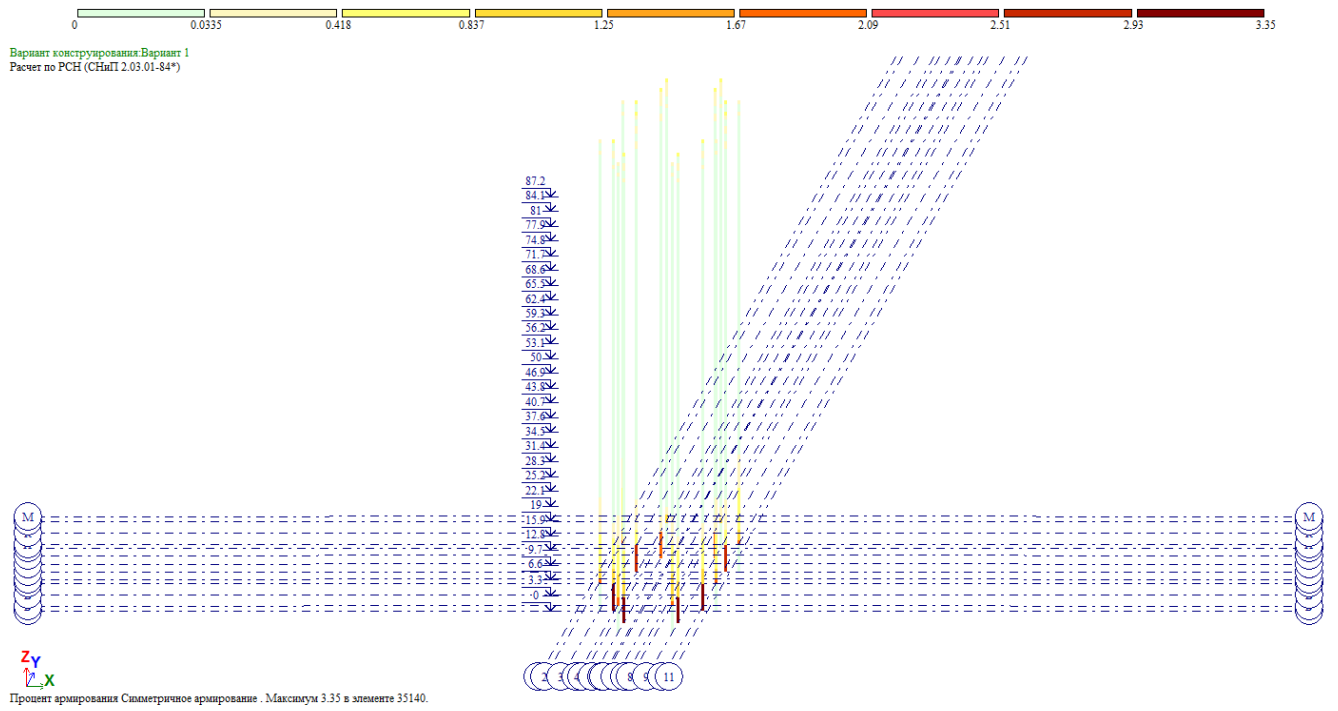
Процент армирования колонн от первого и второго сочетания нагрузок
